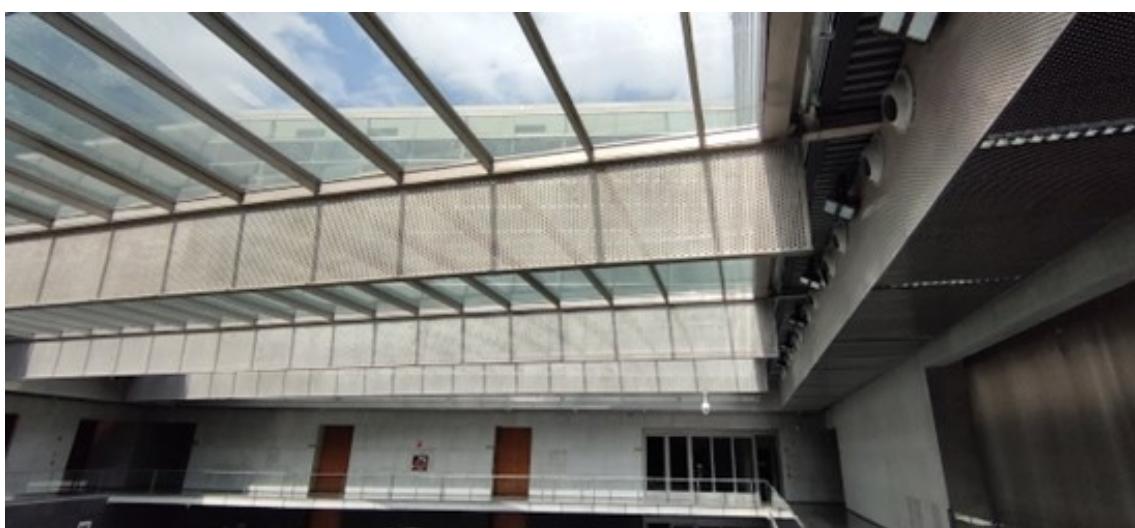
Detalle de la cubierta del atrio [F.A.A.]
